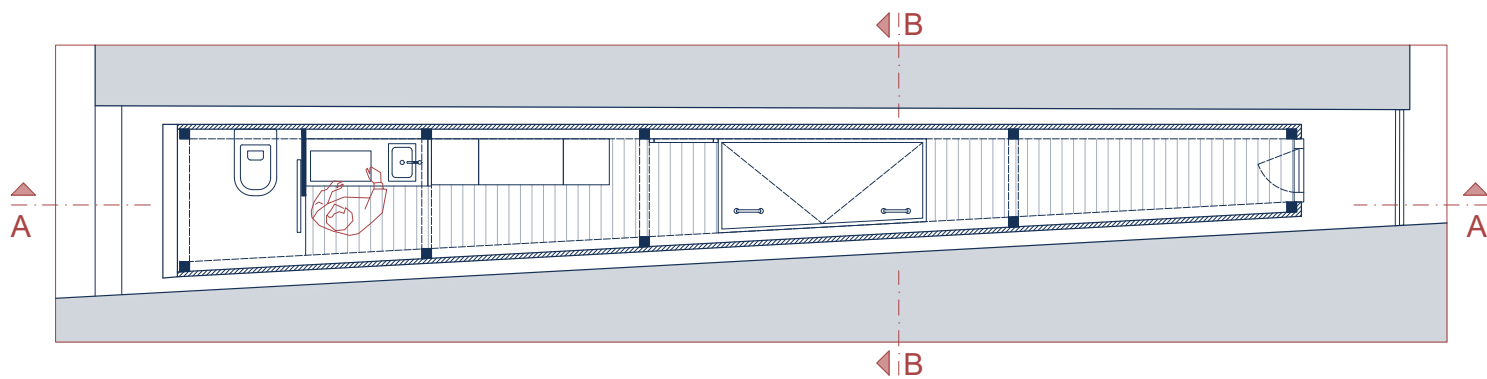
Pianta piano terra, rielaborazione propria - scala 1:50
